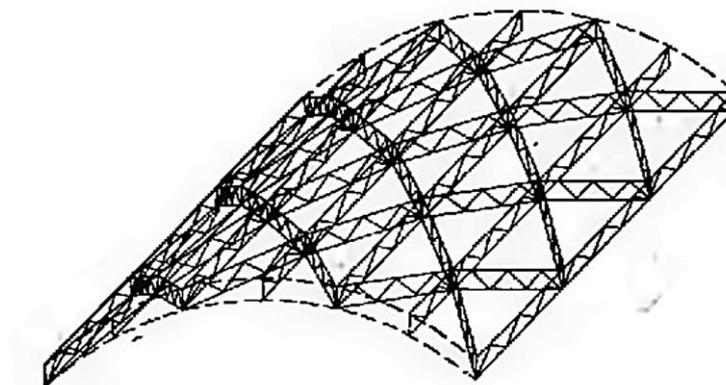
Конструктивное решение двухпоясной оболочки
